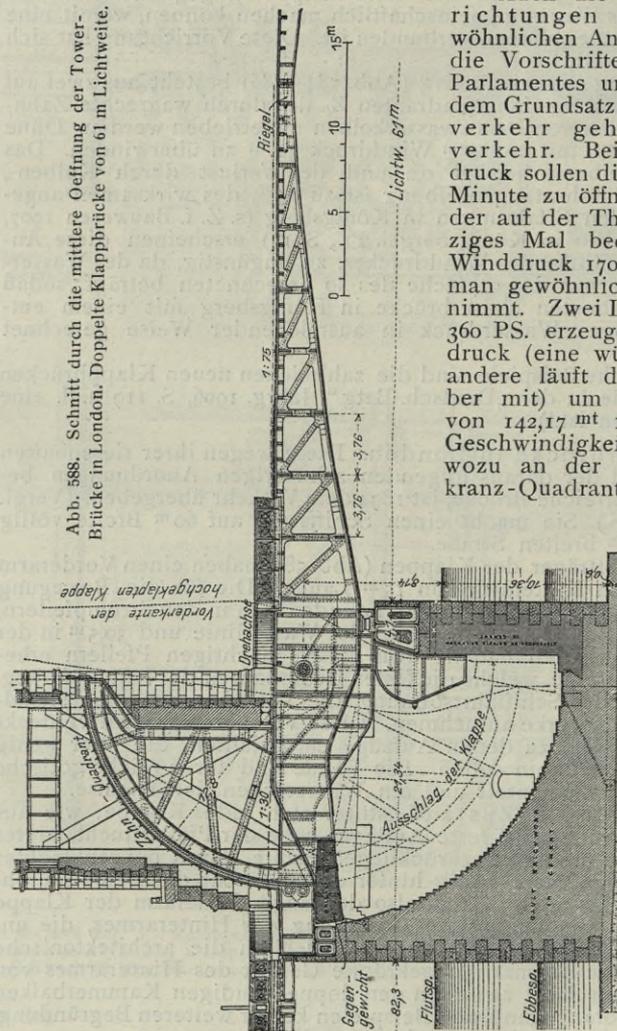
Schnitt durch die mittlere Oeffnung der Tower-Brücke in London. Doppelte Klappbrücke von 61 m Lichtweite.
